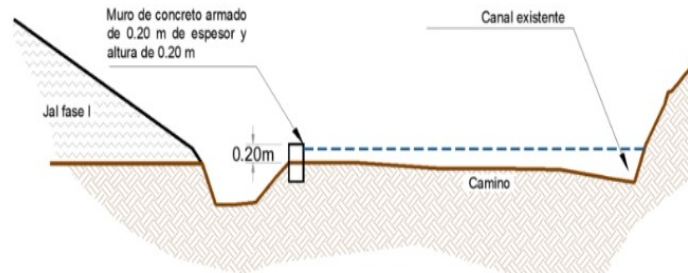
Sección del canal de desvío 1 vista norte a sur
